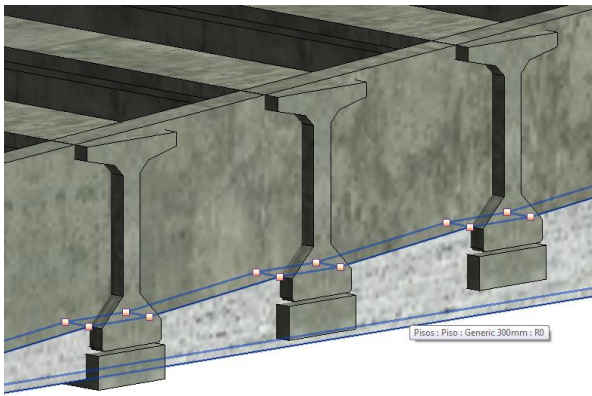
União da laje e da parede para seccionar e definir a base da carlinga.
